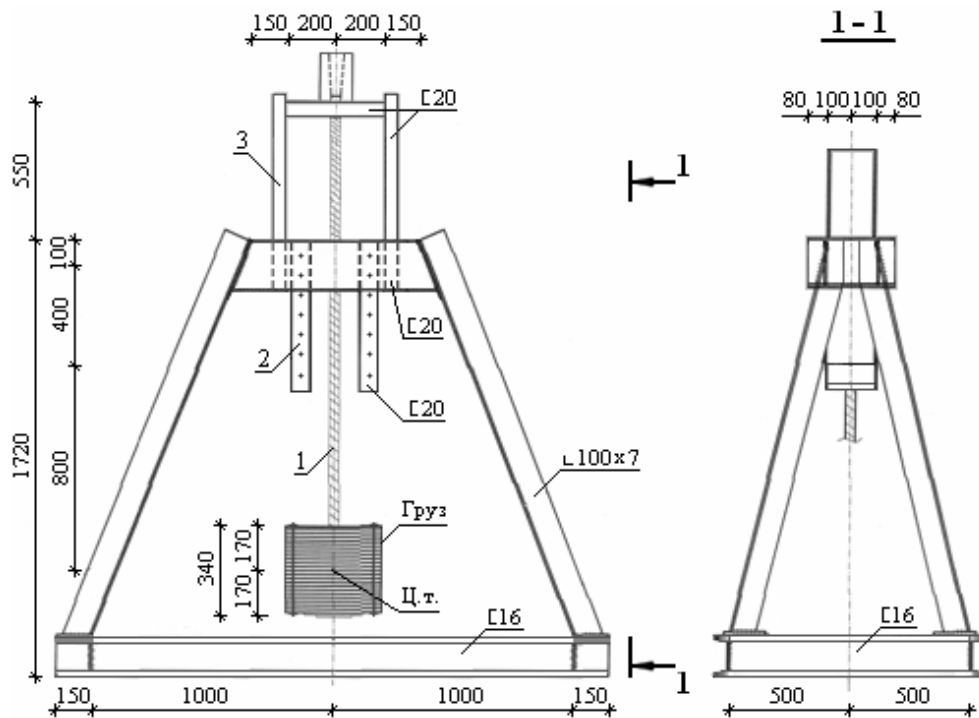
Принципиальная конструктивная схема динамического маятникового гасителя колебаний типа ГК-1 для вытяжных башен-труб:
